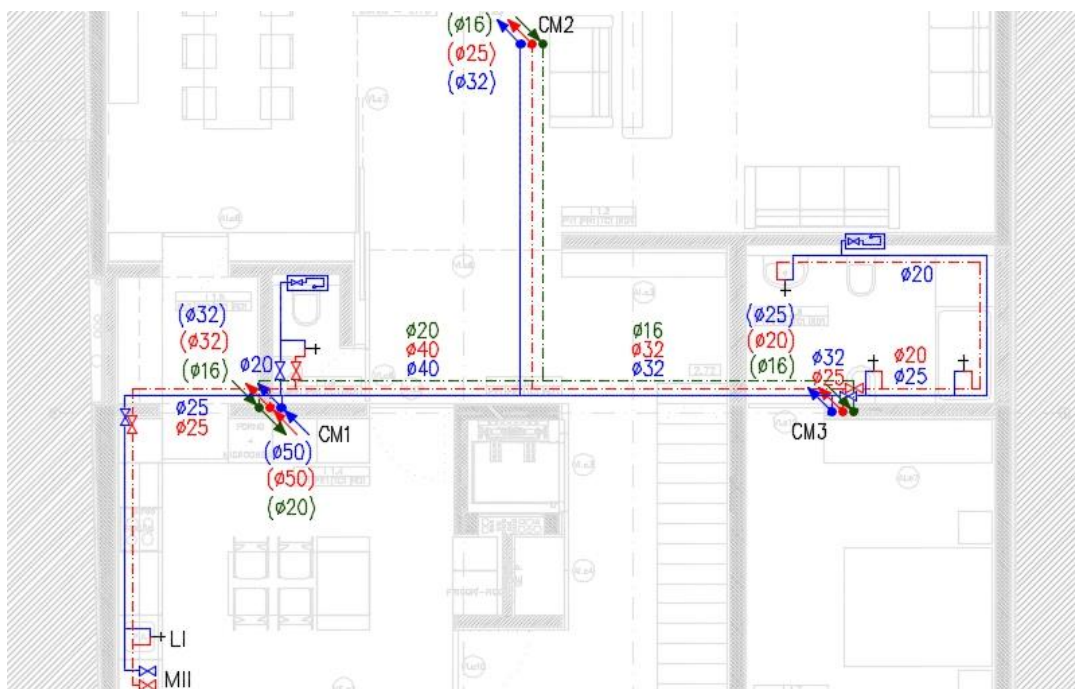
Planta do piso 1 do projeto de abastecimento de água
